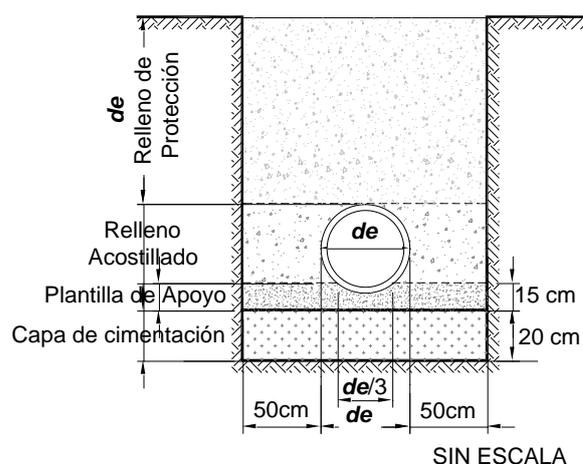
a Relleno de la excavación de zanja en tubería de PAD Corrugado.
